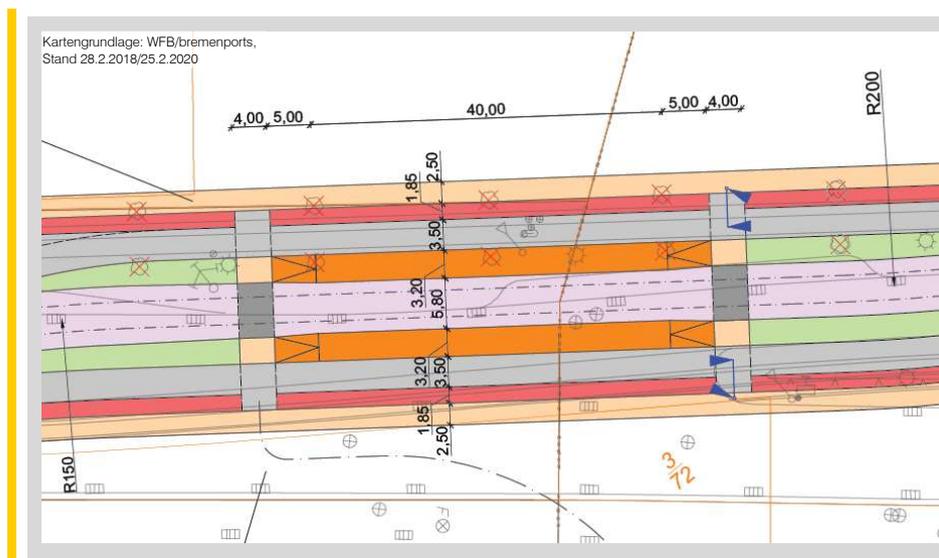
Ausschnitt Lageplan Haltestelle am Europaplatz
